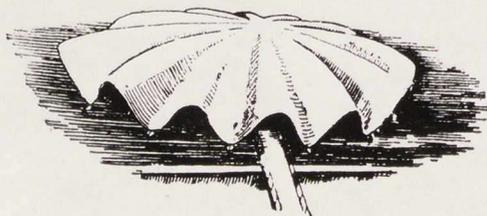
Сан-Хуан (Пуэрто-Рико). Железобетонная оболочка
